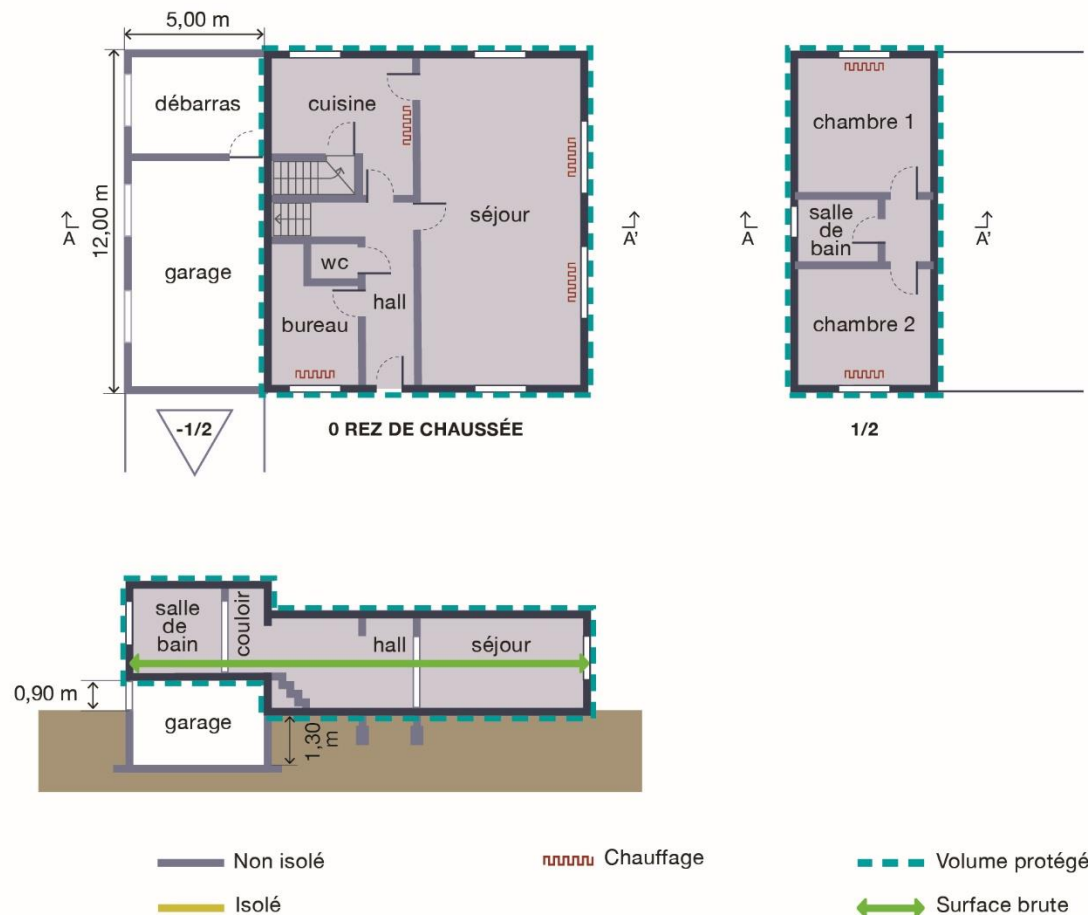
Plan au sol d'une villa (split-level) avec garage et remise semi-enterrés
